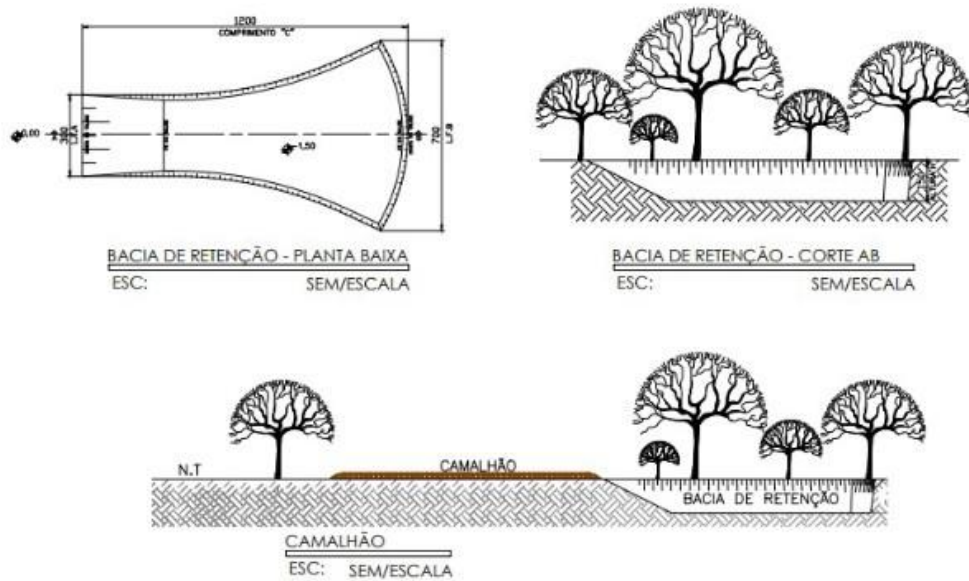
Estruturas a serem implantadas nas estradas já existentes. Fonte: PCA.
